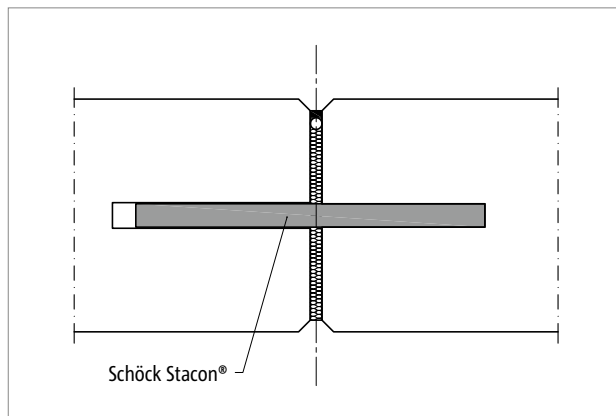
Schöck Stacon®: Dehnfugenausbildung Ort beton
